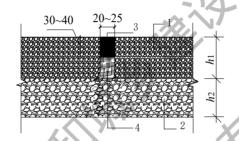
胀缝构造剖面图 1-透水面层; 2-混凝土基层; 3-填缝胶; 4-柔性填缝材料
